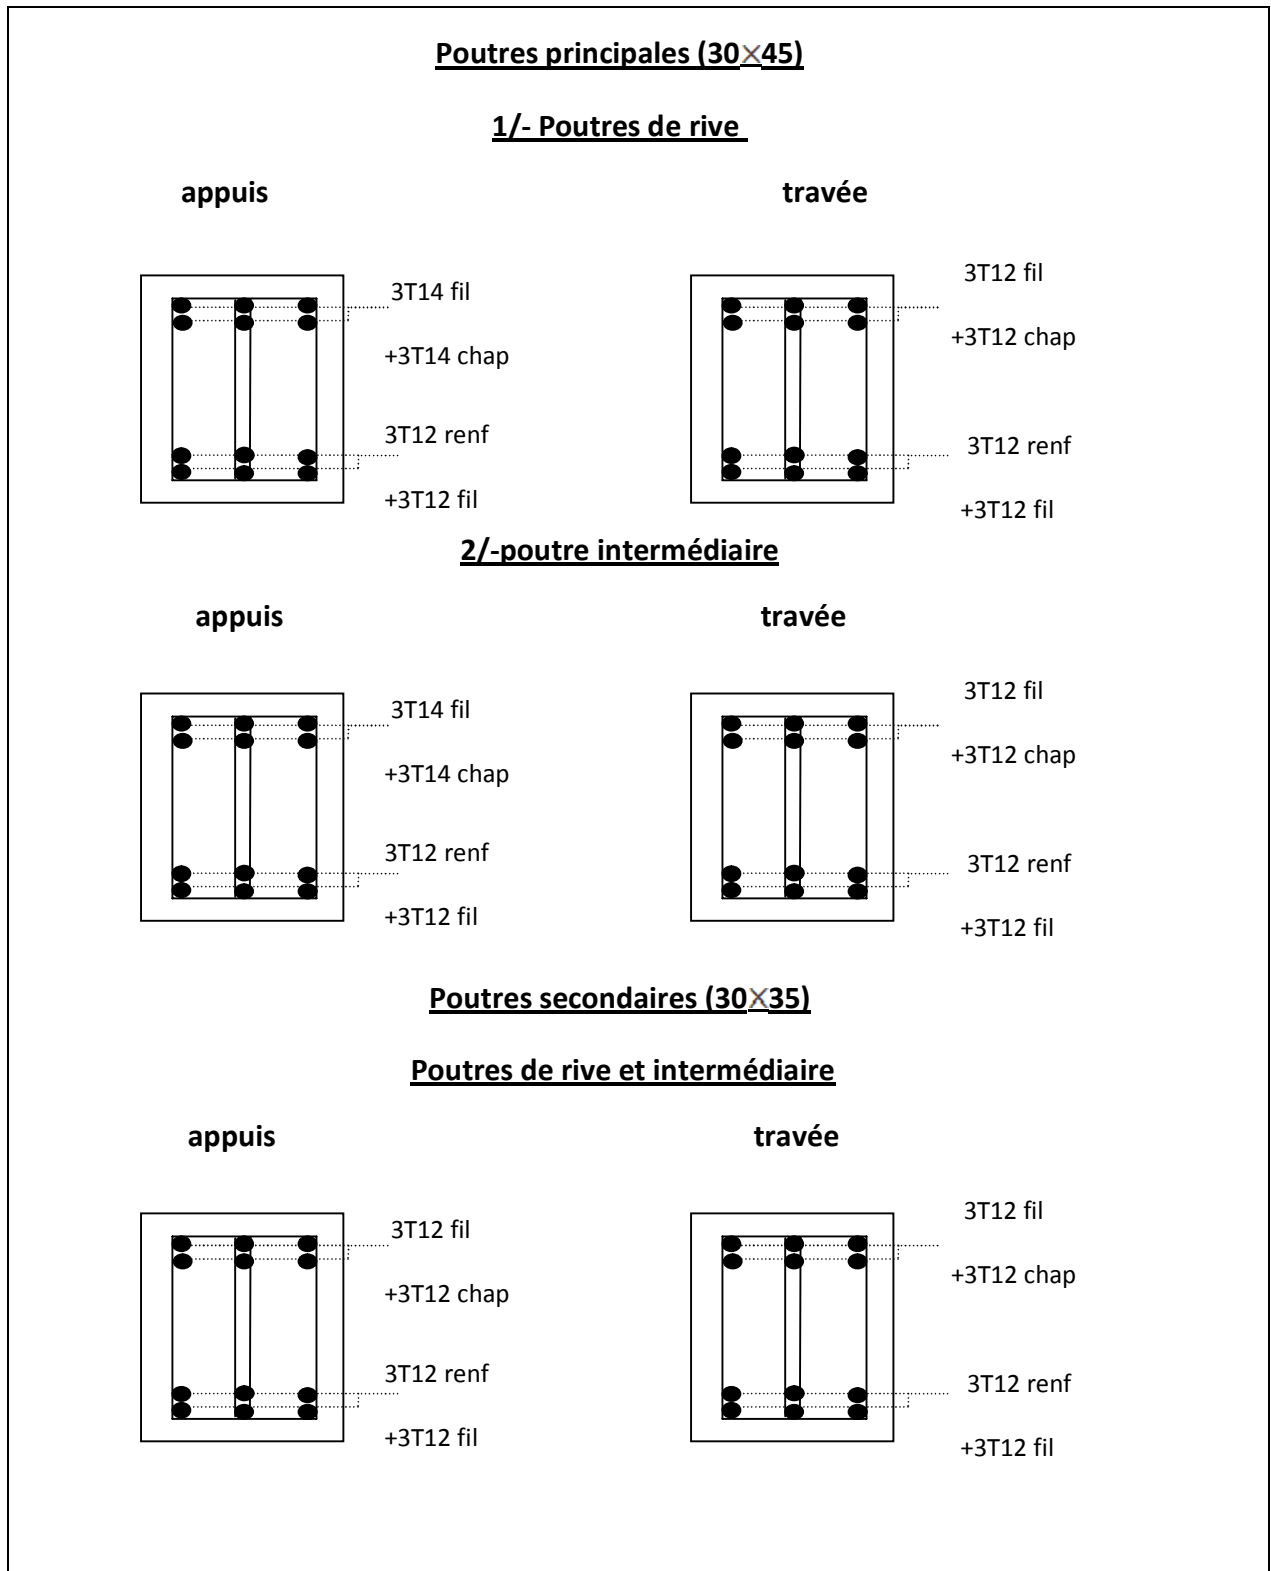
ferrailage des poutres Principales et Secondaires BLOC C
